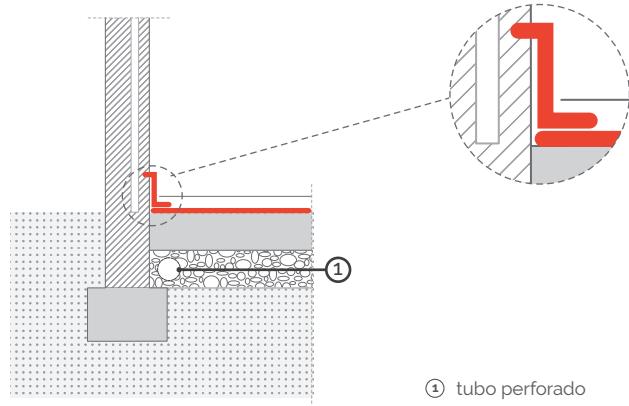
Encuentro de la barrera tipo lámina con una fachada mediante encastrado y tubo perforado
